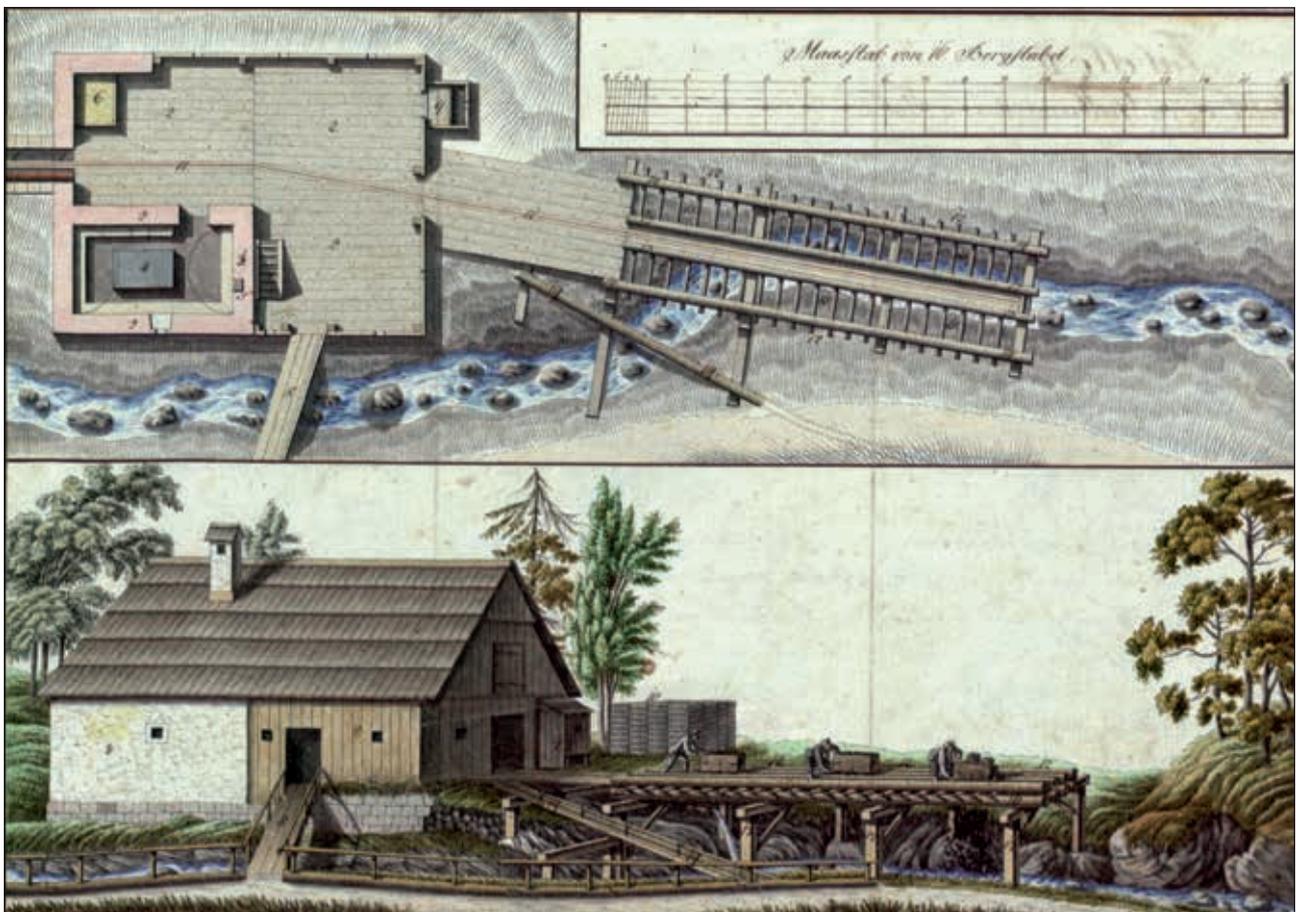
Mundloch-Stollenhütte im Grundriss und perspektivischem Aufriss mit der daran angebauten Sturzhalde
